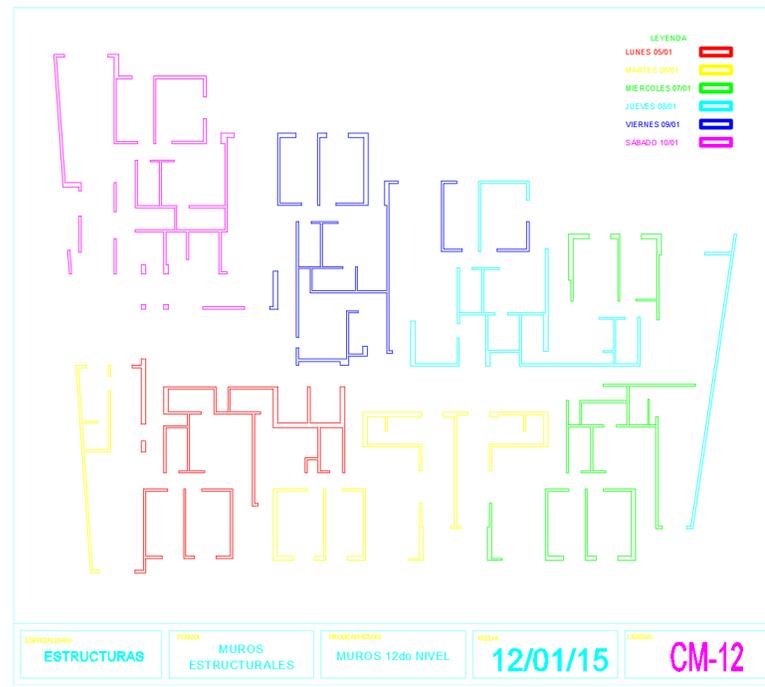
Sectorización de Muros Nivel 12. Fuente: Elaboración Propia
